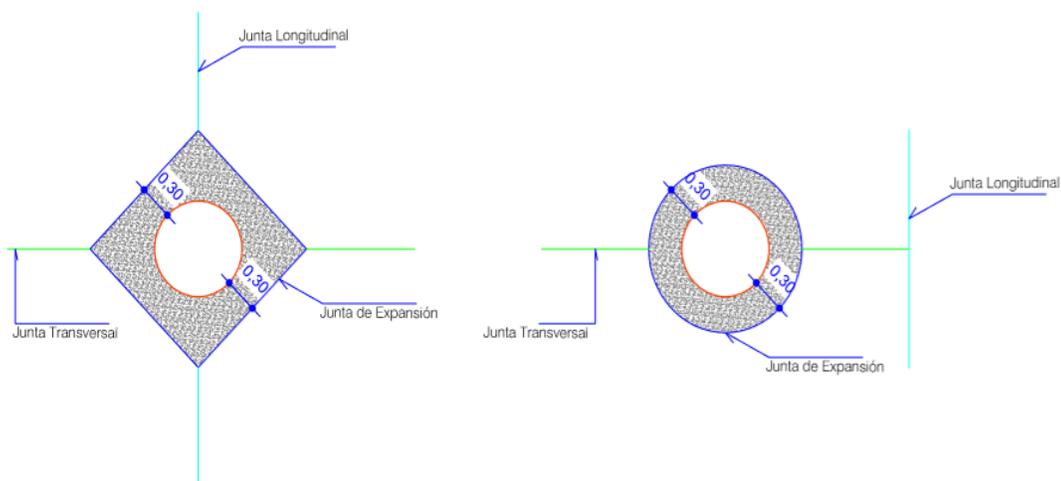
Detalles generales de junta en pavimento rígido. Fuente: AMO, 2019.
